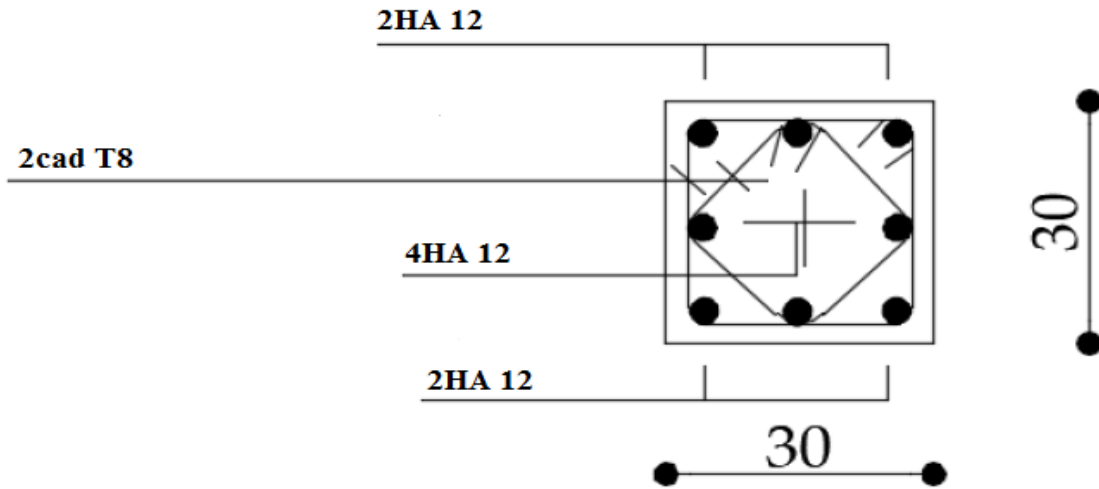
Schéma de ferrailage des poteaux (30 × 30)
